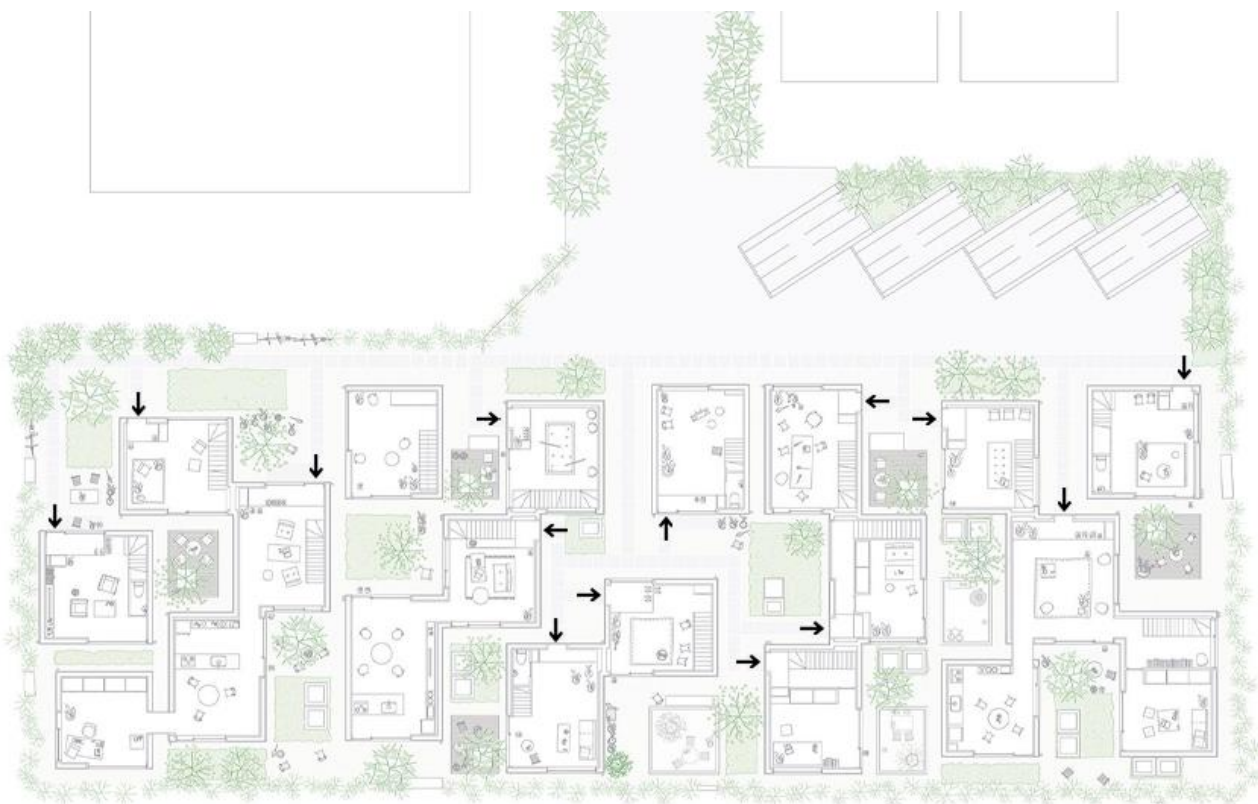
Schéma des entrées individuelles du projet Seijo Town Houses
